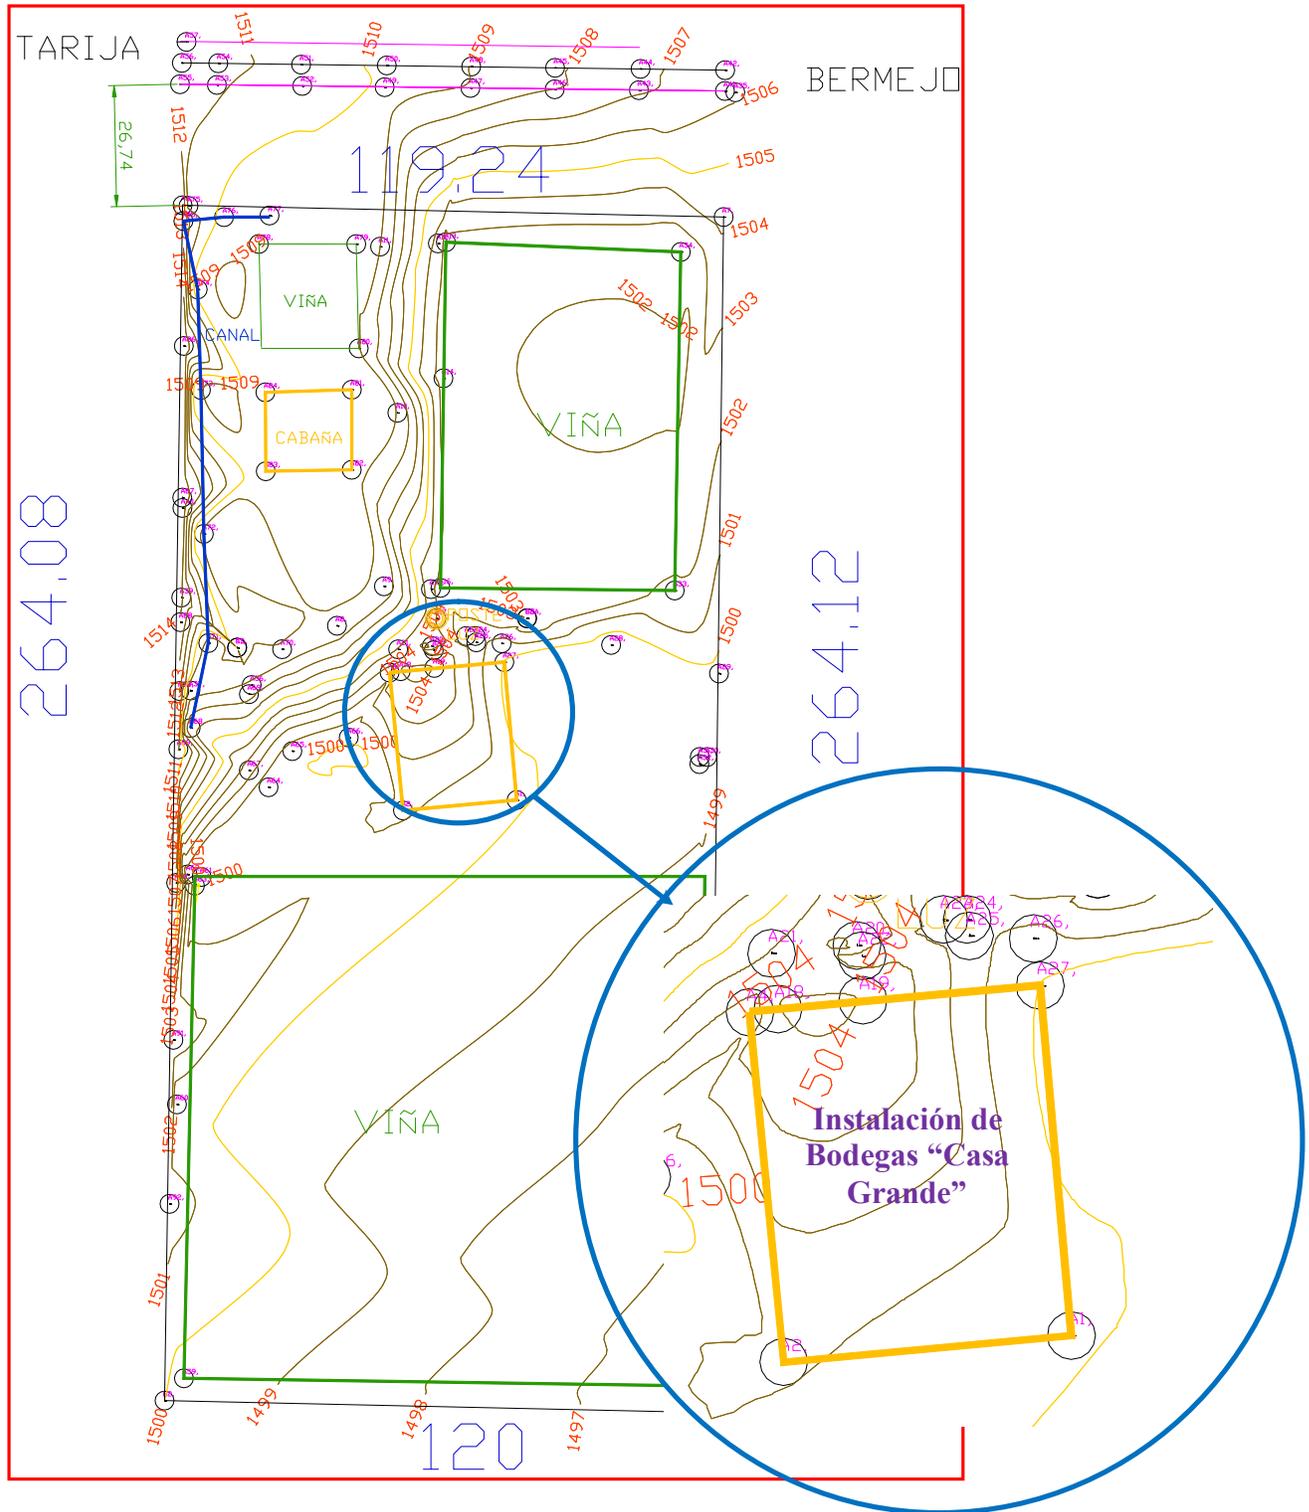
Levantamiento topográfico del área de construcción de la nave industrial de Bodegas y Viñedos Casa Grande.
